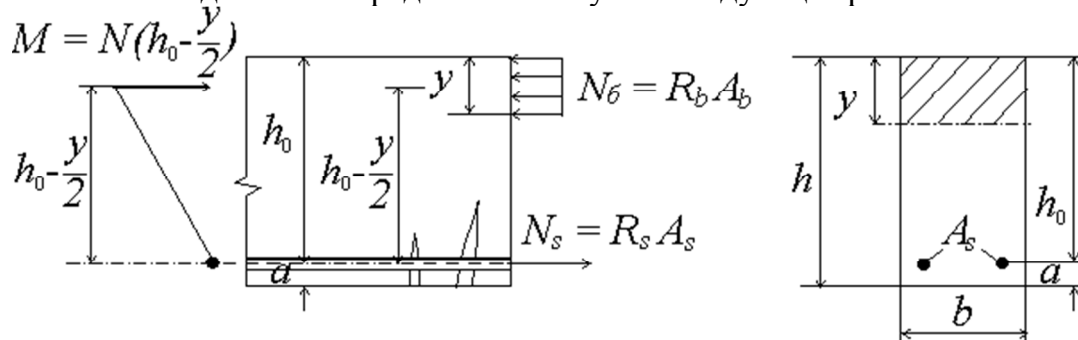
Схема усилий для приведенного прямоугольного поперечного сечения железобетонной конструкции
